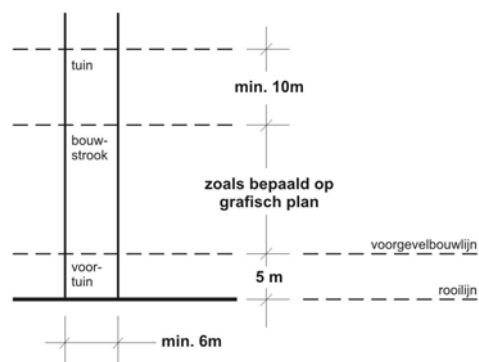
halfopen bebouwing: verkavelingsvoorschrift
